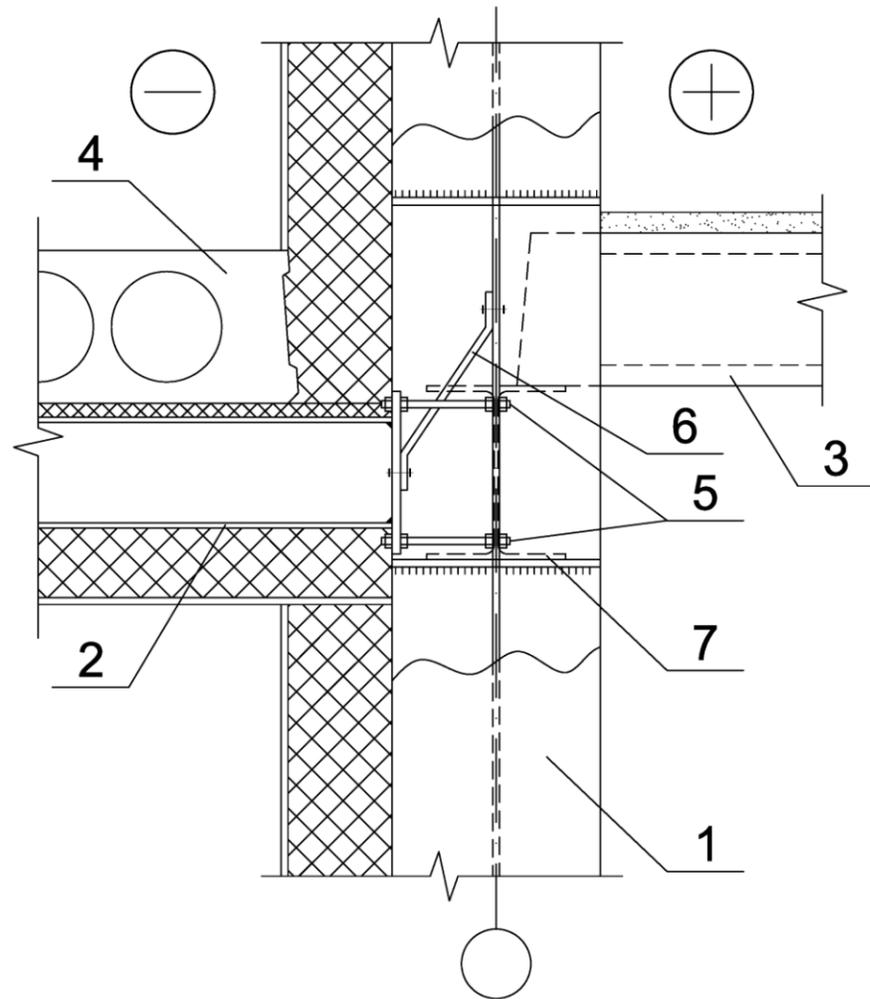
Конструктивное решение балкона со стороны главной балки.
